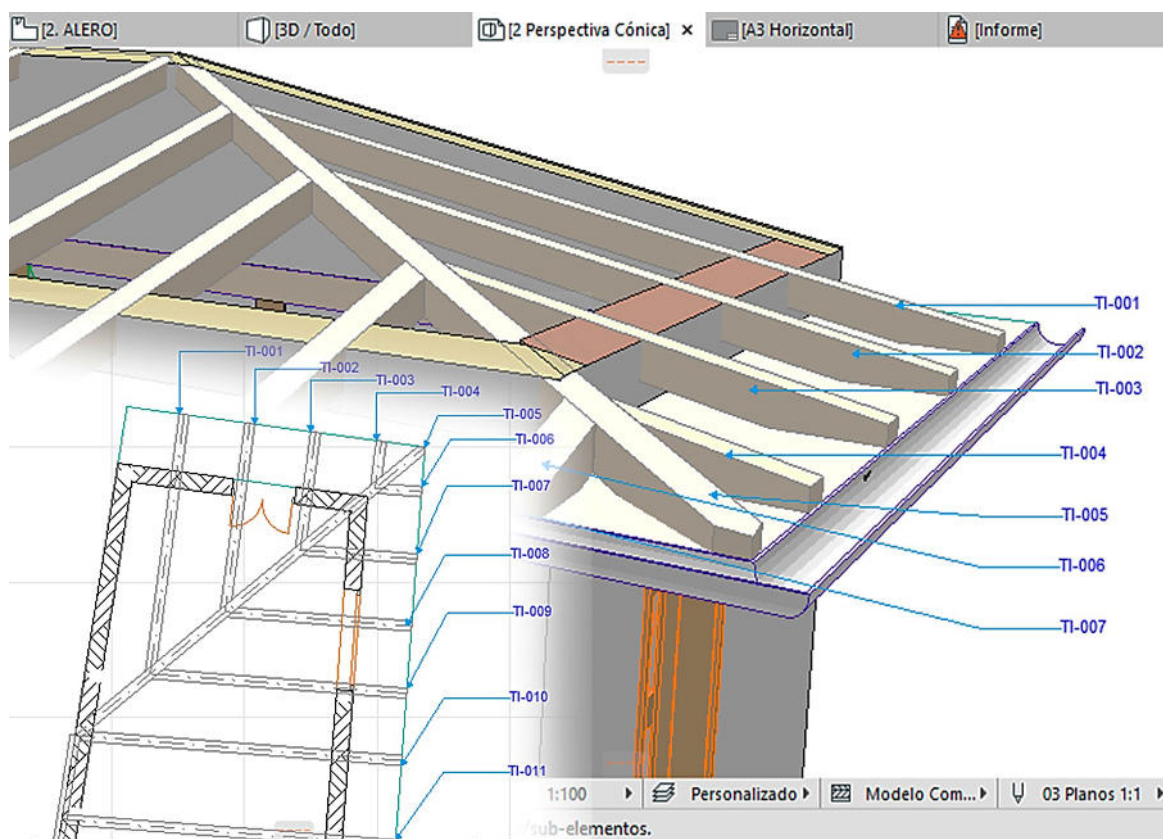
Planta y perspectiva vigas de cubierta, identificación de etiquetas que muestran el ID
